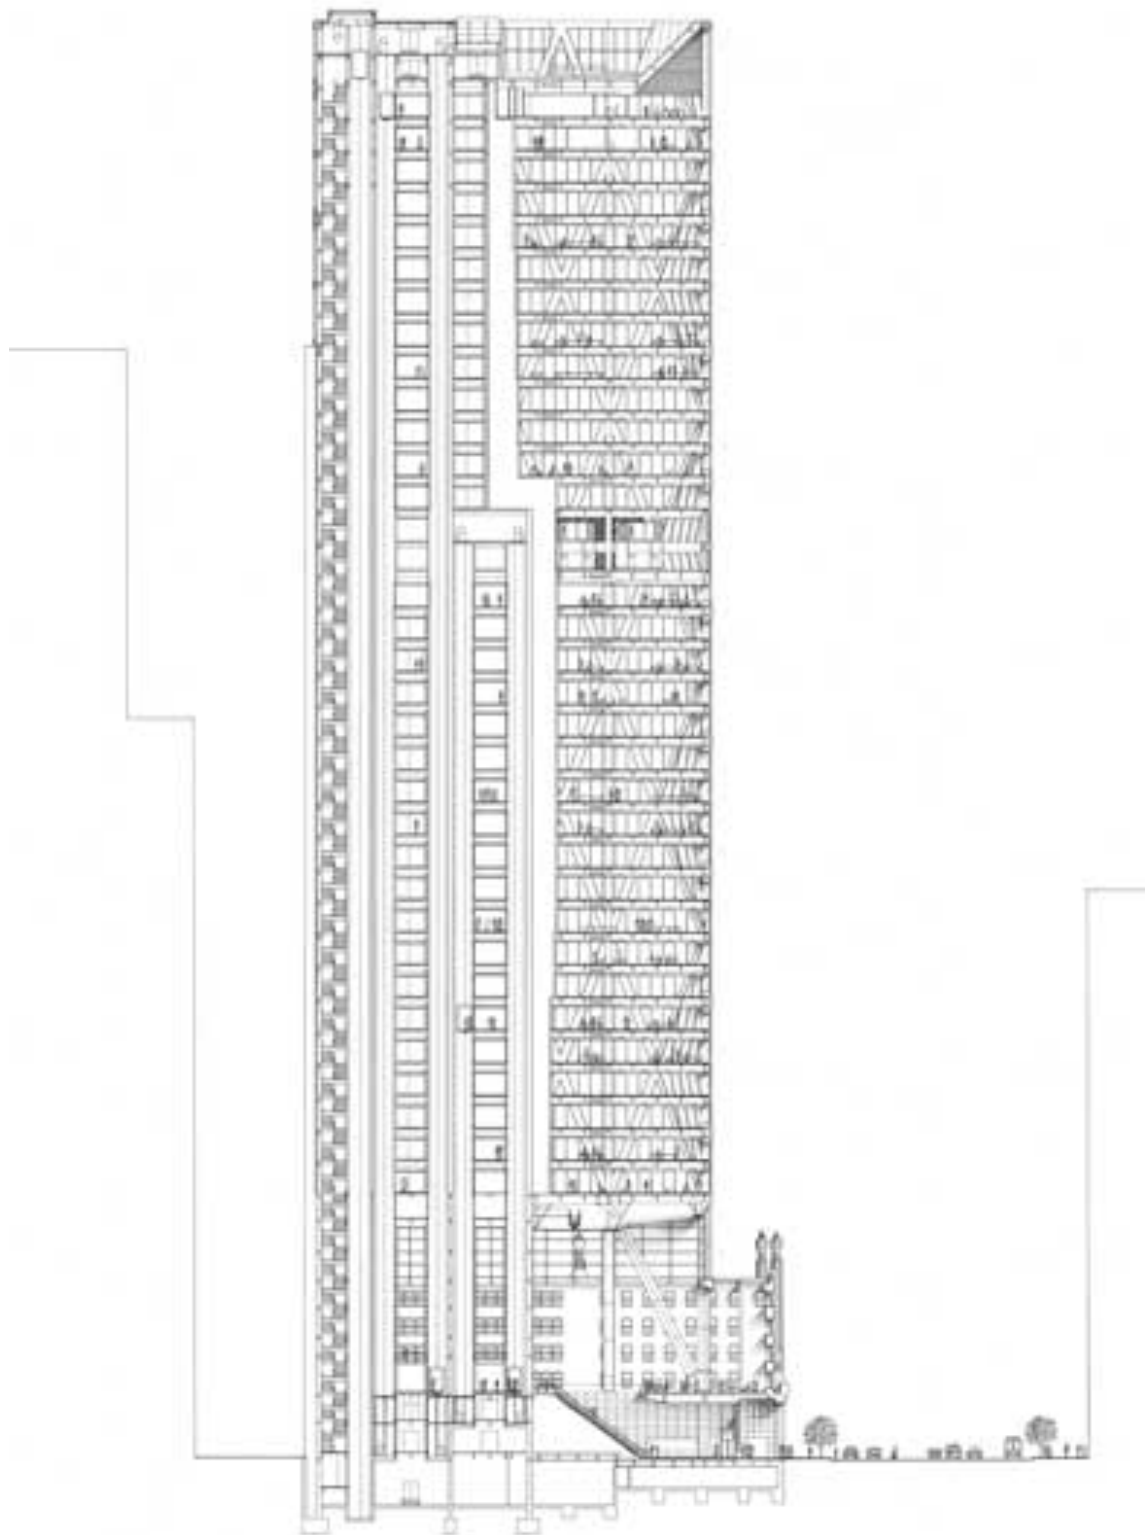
Alzado este. Fuente: Foster+Partners. (2010). *Hearst Tower
